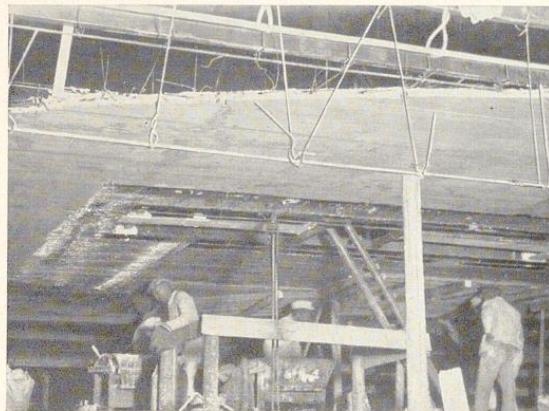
Gußrabitzdecke mit einer Aussparung zur Ausführung der Gießarbeit
